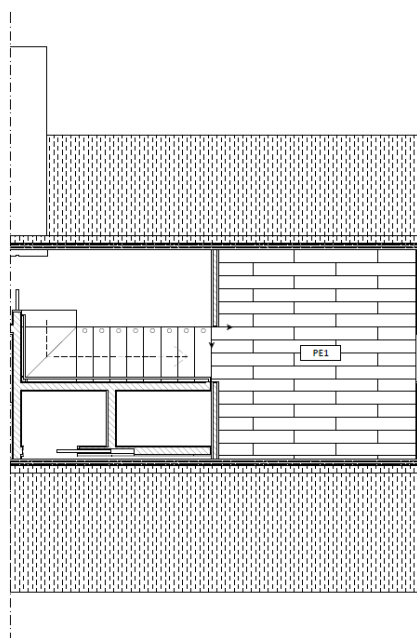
Planta de Pavimento, Alojamento Loureiro, Piso 1, mezzanine.
